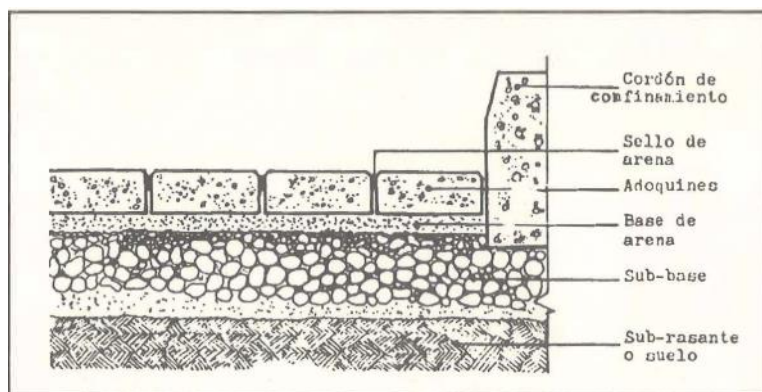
Estratificación de un pavimento articulado convencional. Fuente: (Cobaleda Zapata & Penagos Restrepo, 1990).
